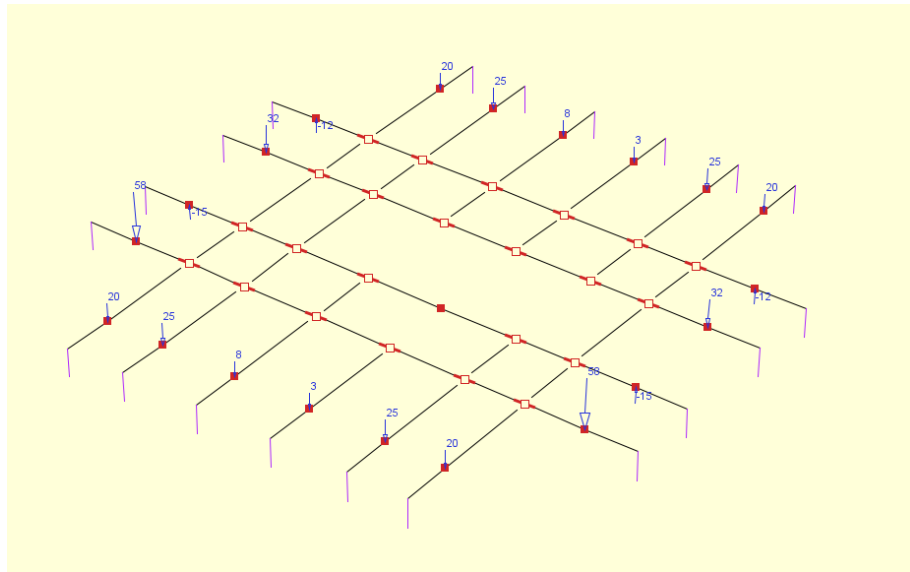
układ statyczny projektowanej konstrukcji (widok z uwzgl. widoku przekrojów elementów)
